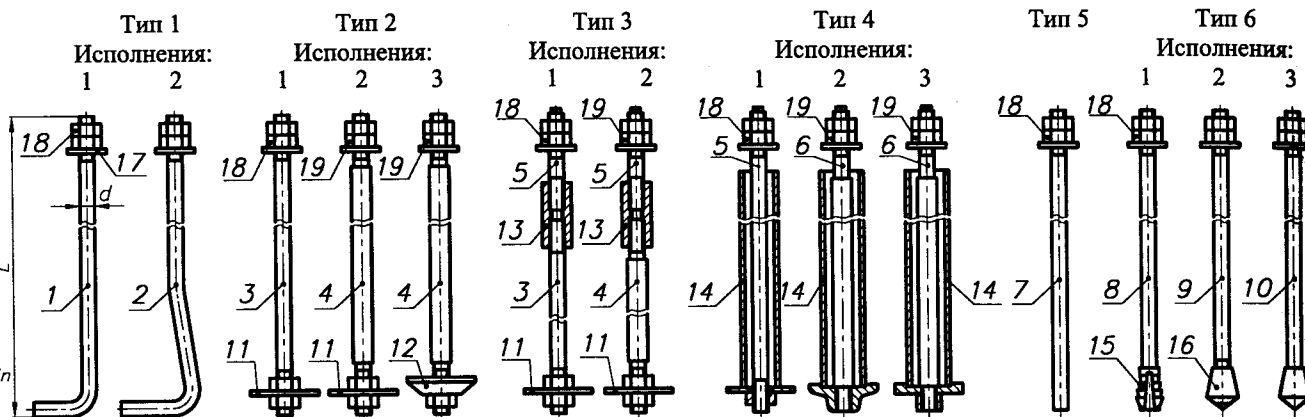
Типы и конструкция фундаментных болтов:
